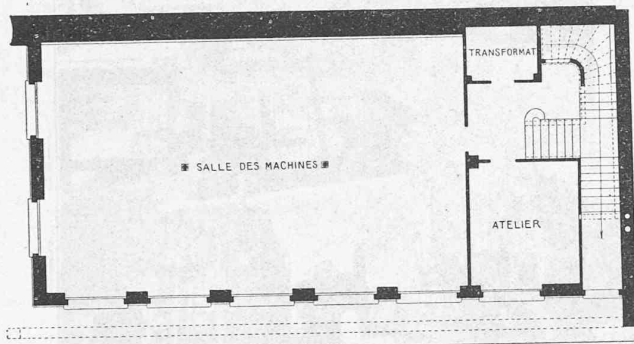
Plan du rez-de-chaussée. — 1 : 250.
